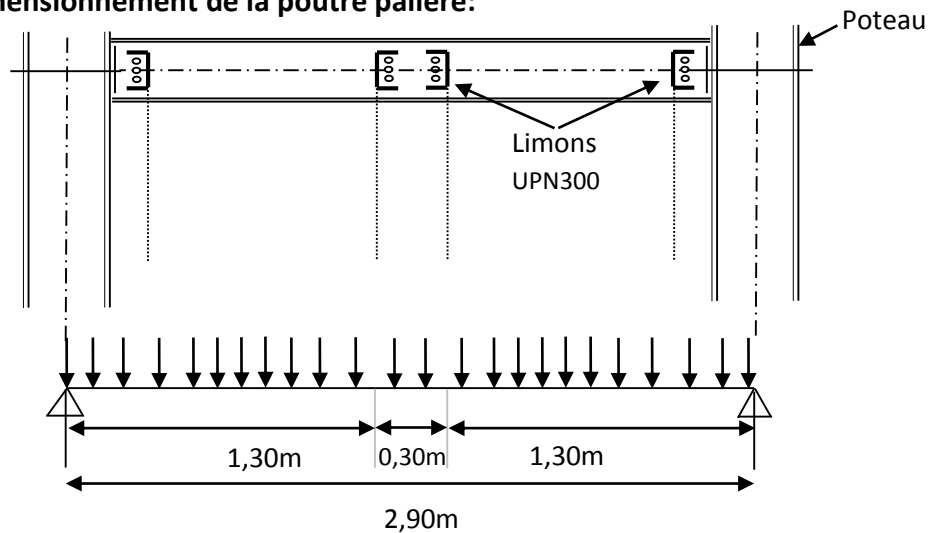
Les charges sur la poutre d'appuis des limons
